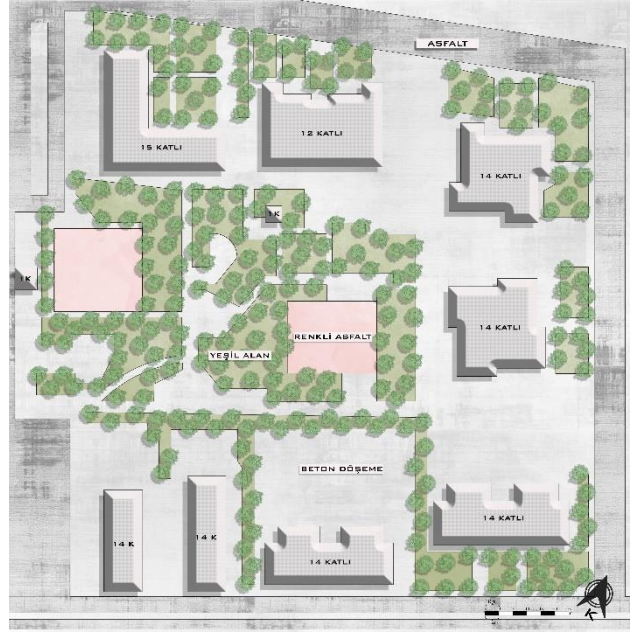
Yeniköy mahallesi çalışma alanı planı
